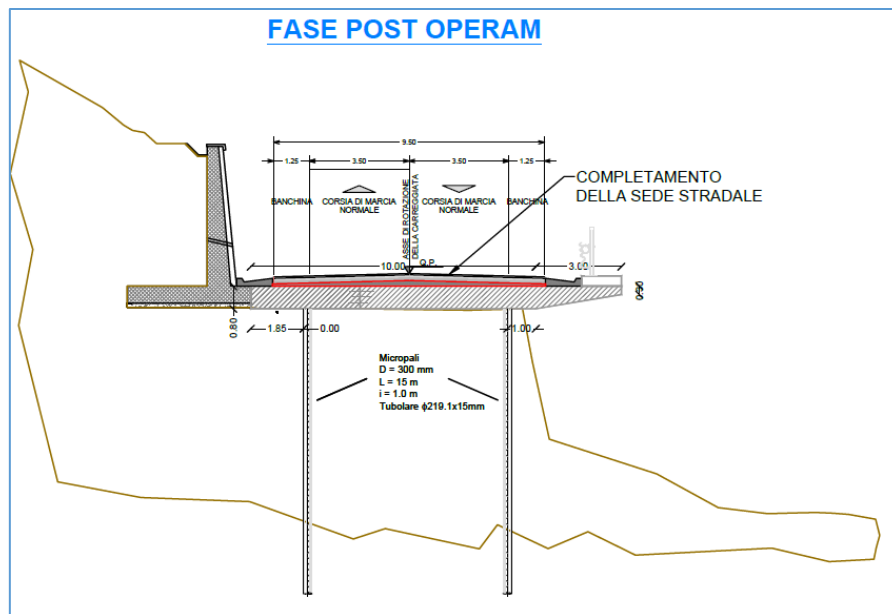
d – Sezione tipo 3 – Post Operam
